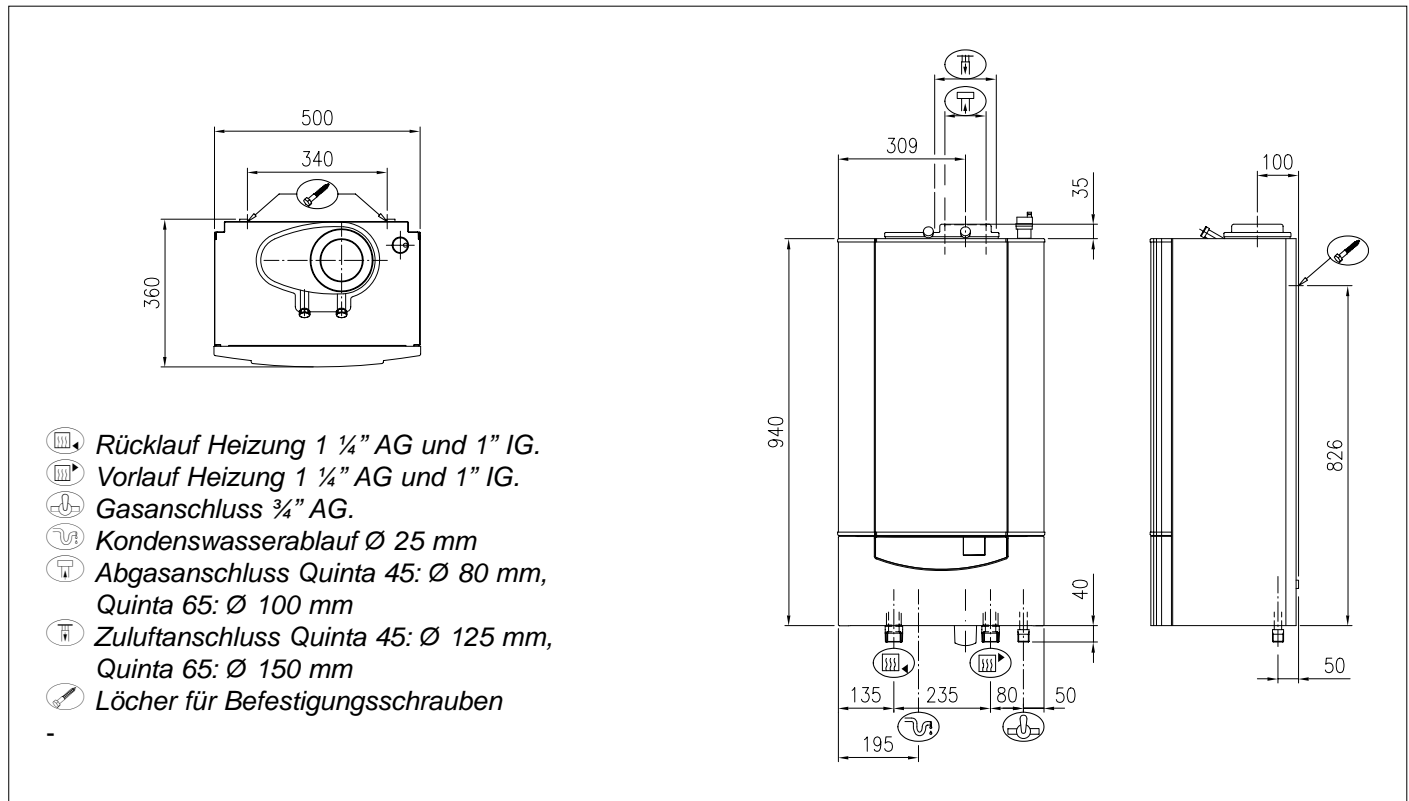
Abmessungen Remeha Quinta 45 und Remeha Quinta 65
